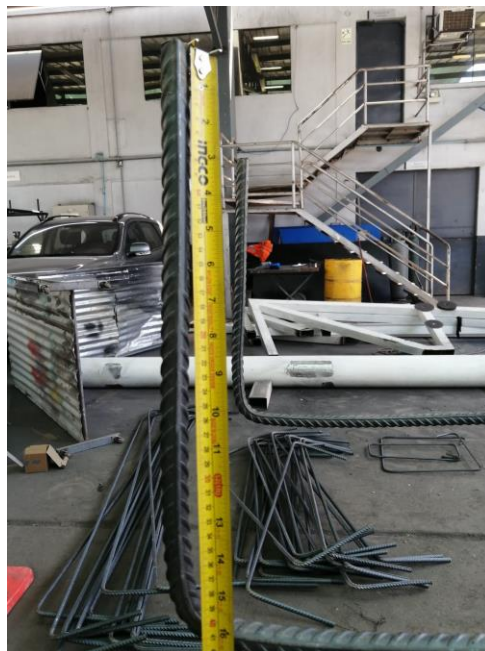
Armado de acero de parrilla. Fuente: Elaboración propia.
